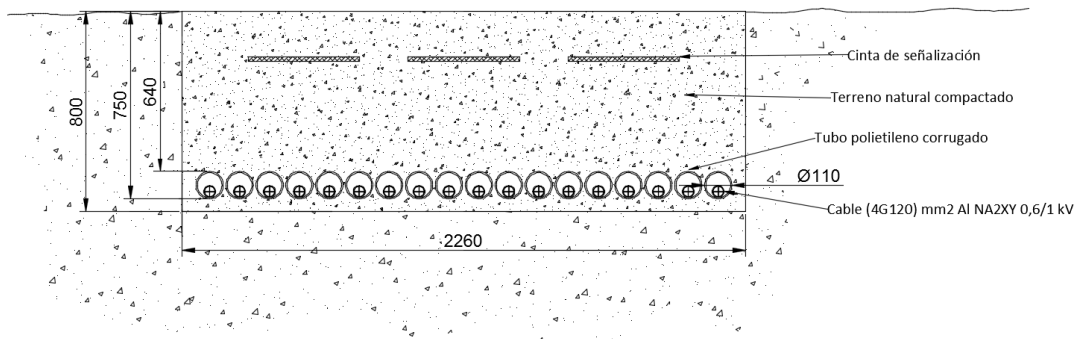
Doc. I. Memoria - Detalle zanja BT. Paso a bajo tubo.
